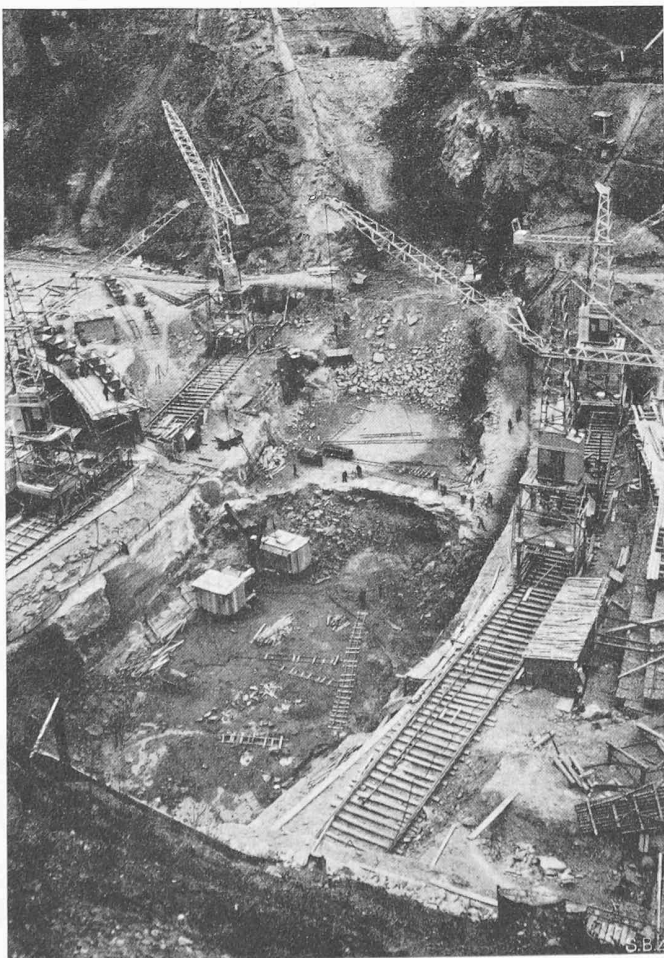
Aushub der Baugrube mit Turmdrehkränen
